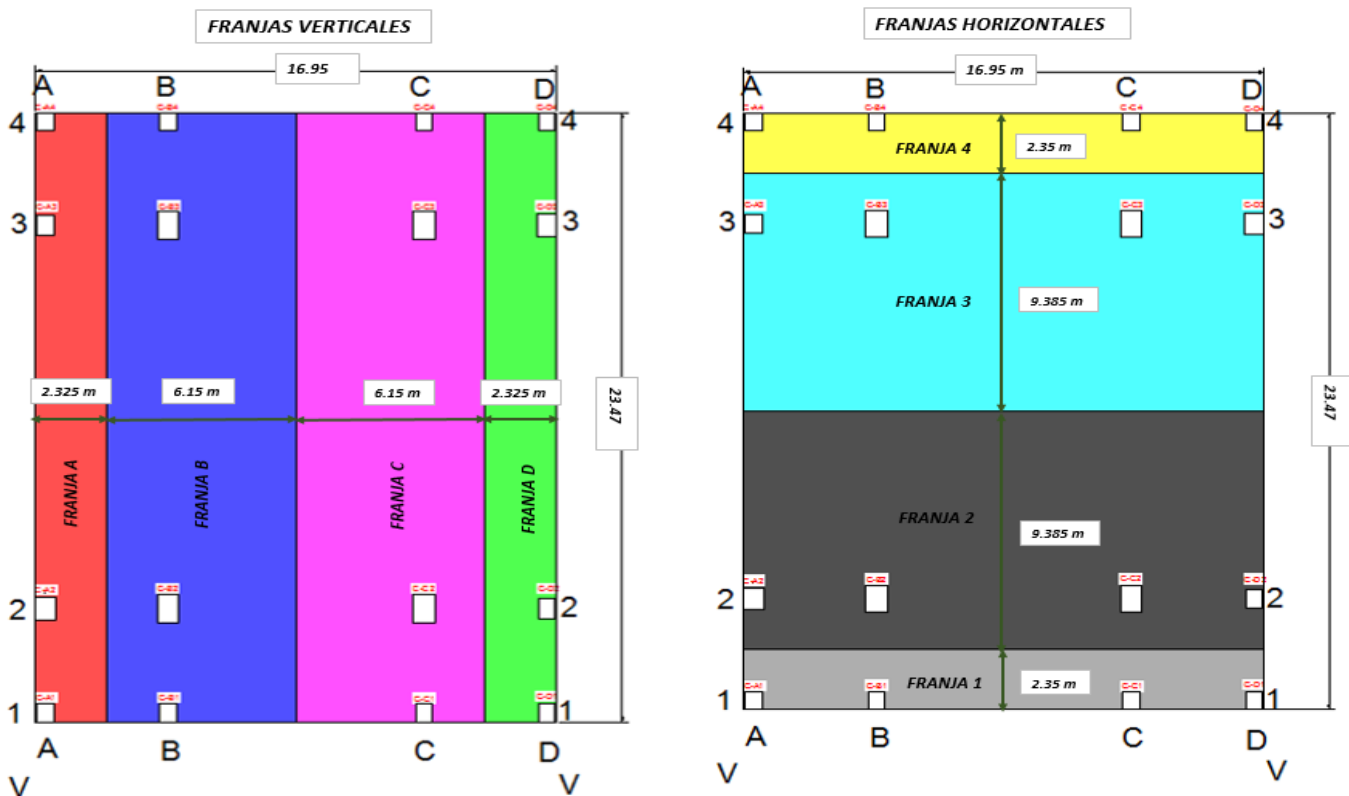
Franjas verticales y franjas horizontales para la losa de cimentación
